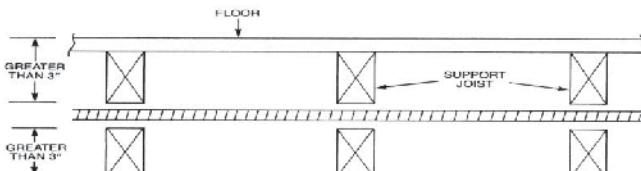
Point de pénétration à plus de 3" du bord d'une poutre, d'un montant, d'une plaque, etc.
